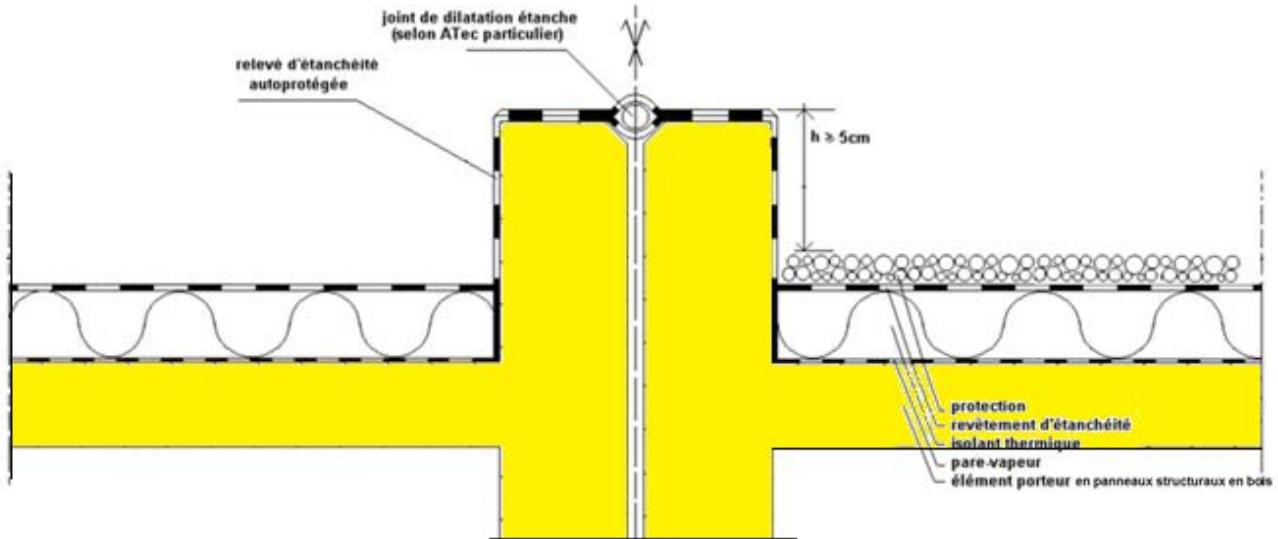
Principe de joint de dilatation en toitures terrasses inaccessibles, techniques
